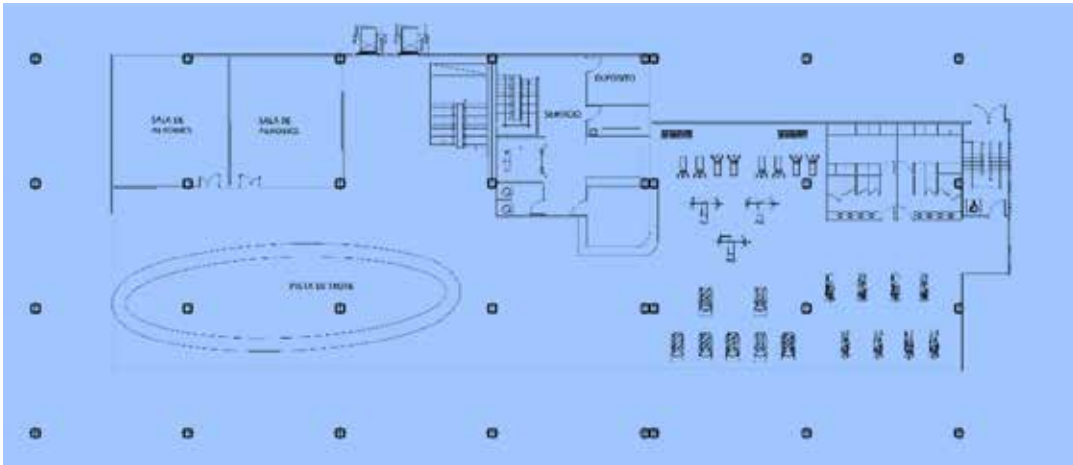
Planta Nivel 3 +14.50 Autora: Cáceres (2017).
